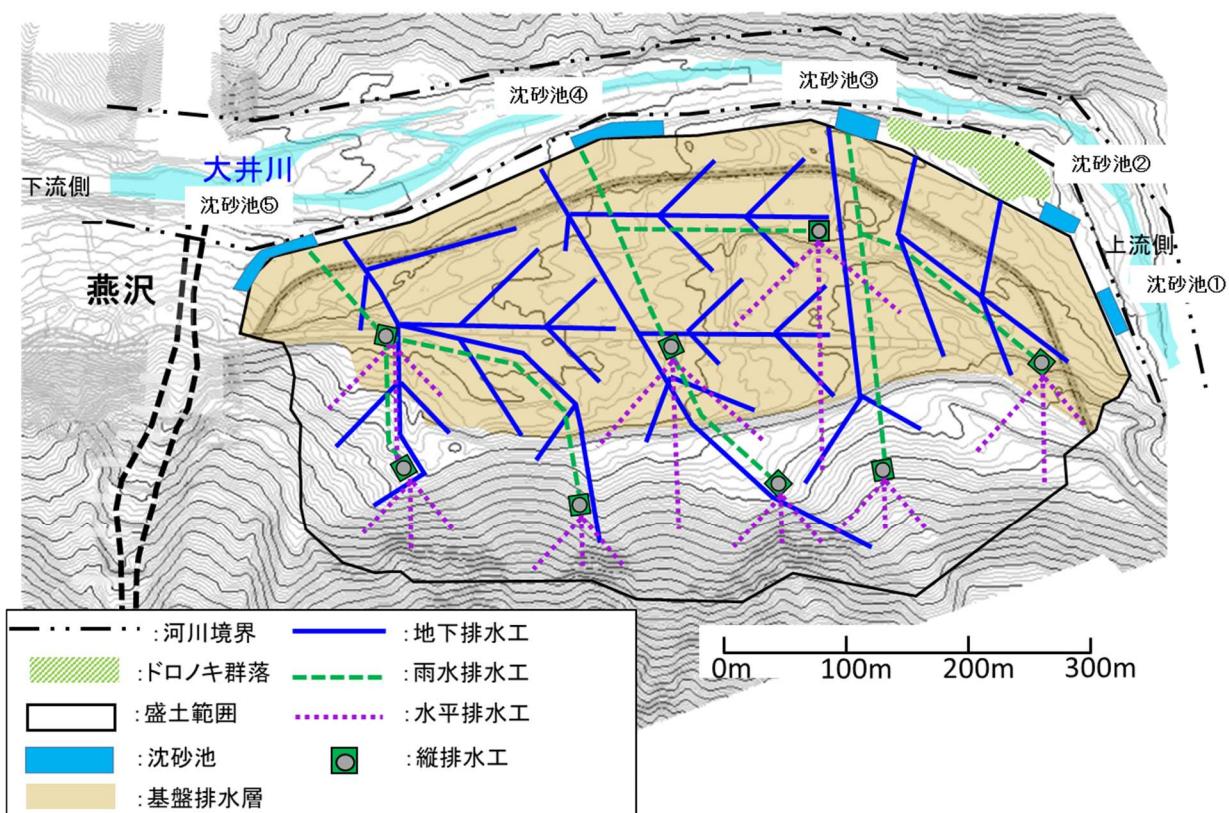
ツバクロ発生土置き場（通常土）の排水設備計画平面図
